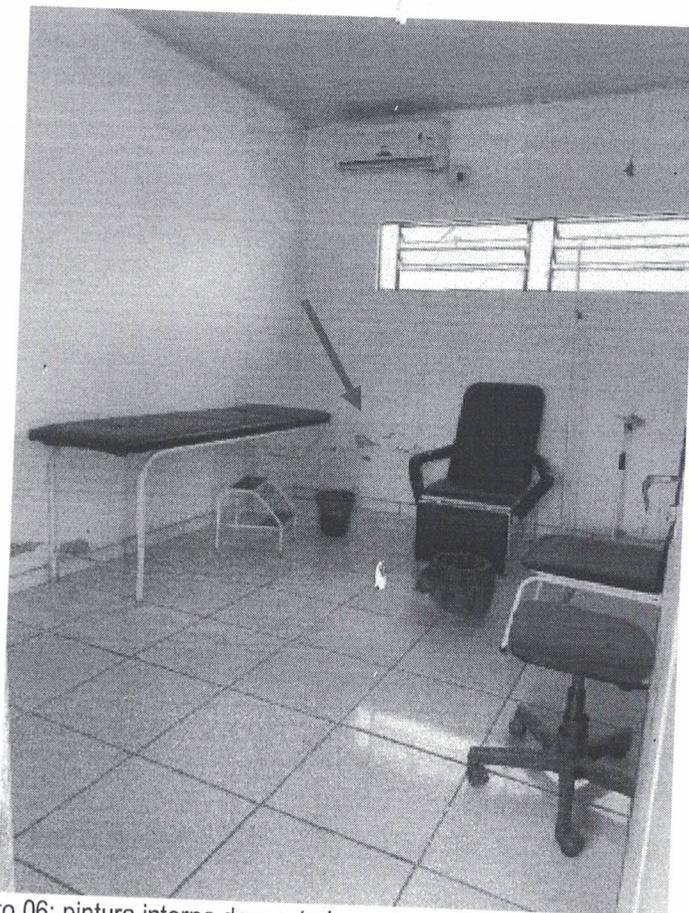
pintura interna desgastada e suja, paredes com infiltrações.
